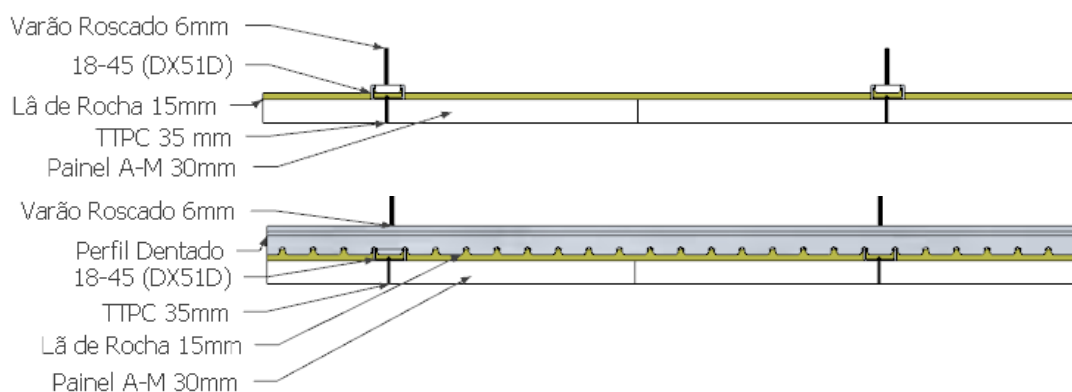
e 3.11 – Solução construtiva 1 e 2 adotadas para o ensaio do teto.
